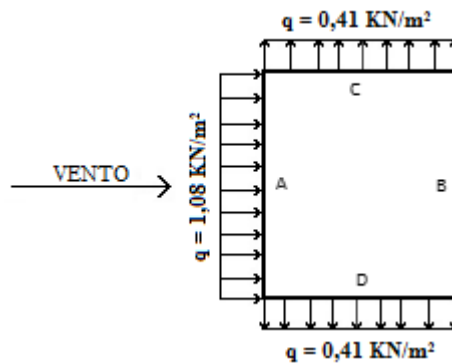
Representação em planta das fachadas e pressões do vento aplicadas
